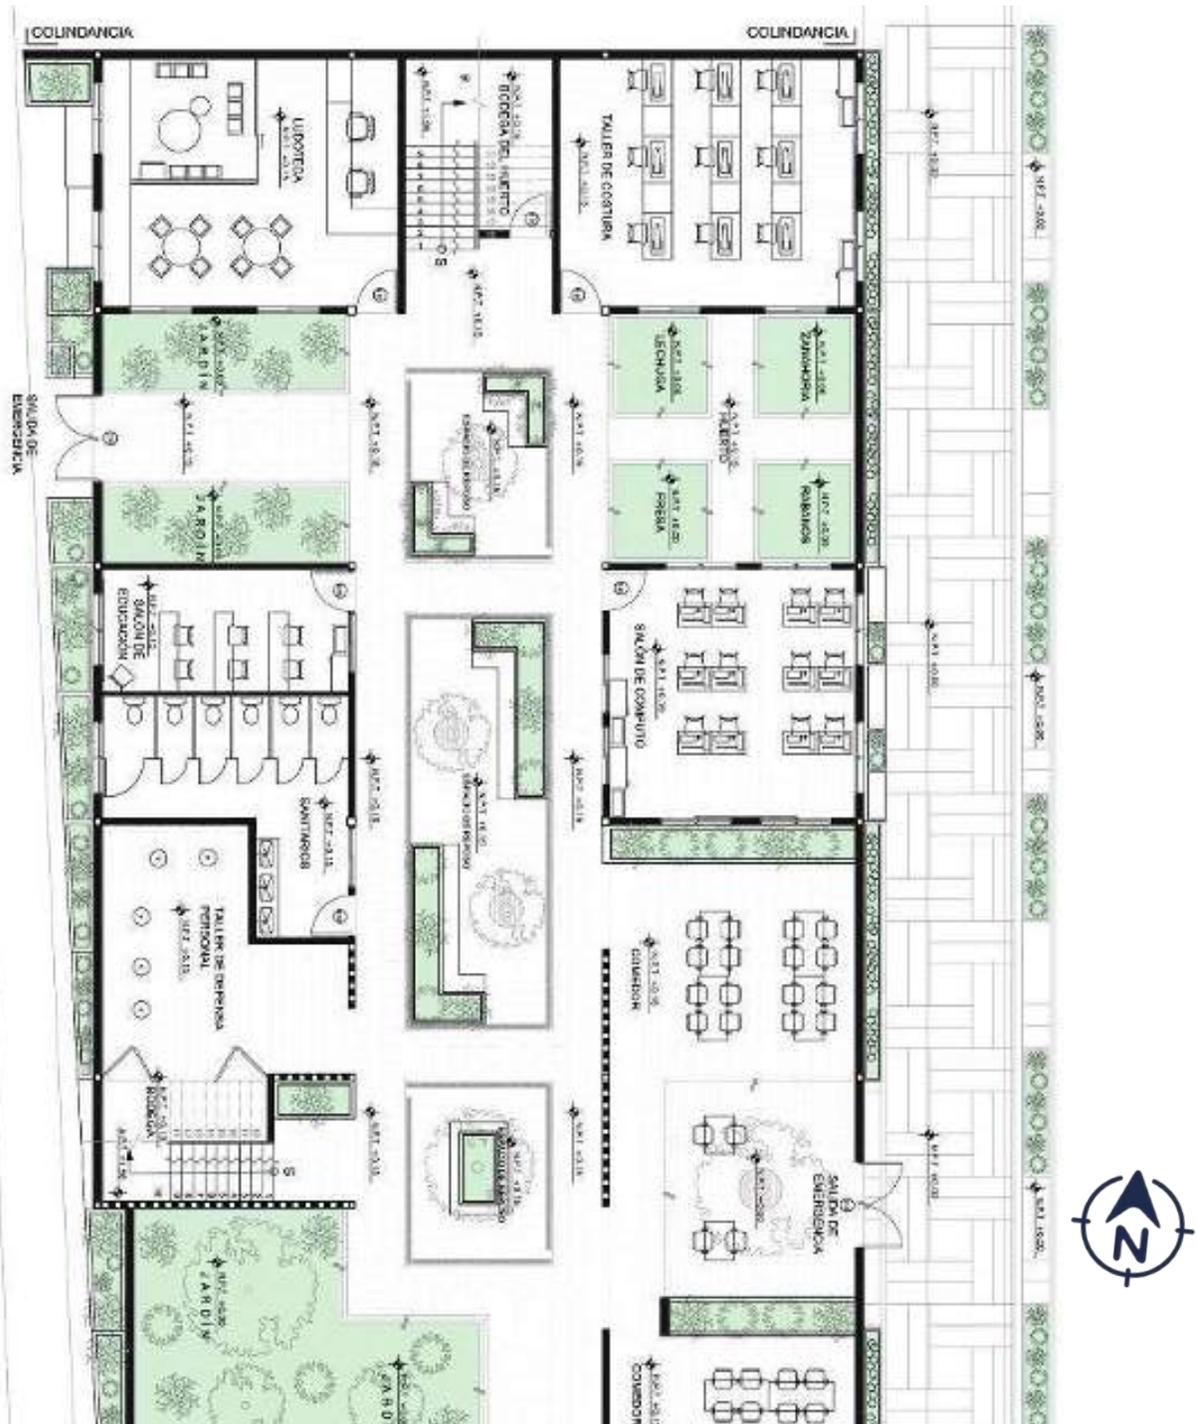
| Explicación de la planta baja ambientada de MUSAS
